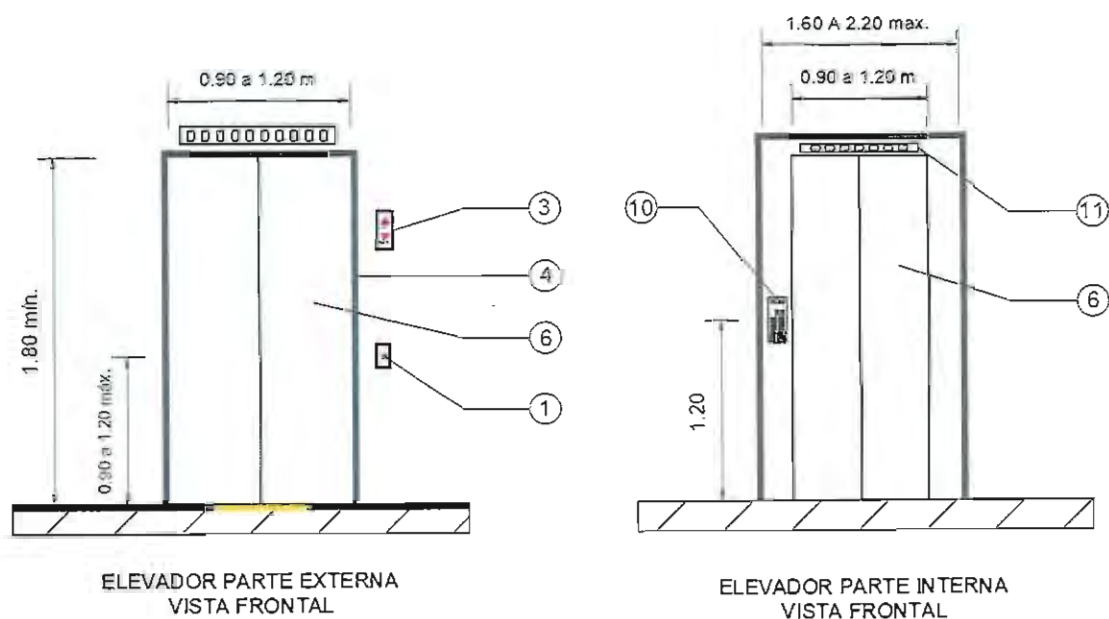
Elevador parte interna y externa - Planta arquitectónica.
